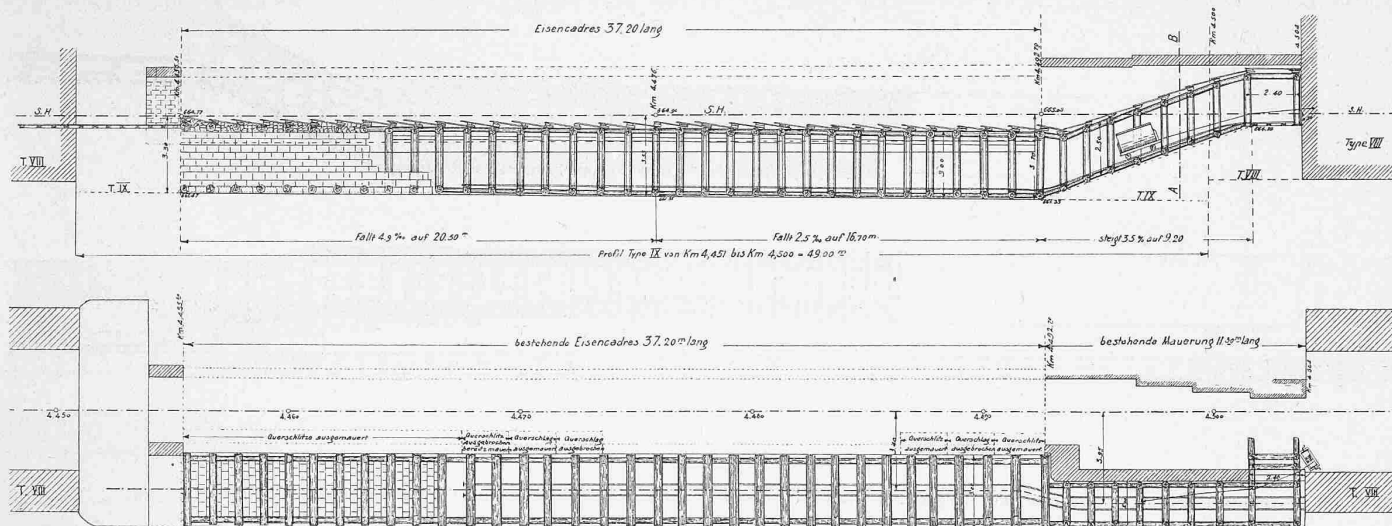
und 5. Grundriss und Längsschnitt des Unterstollens rechts (östlich). — Masstab 1 : 300.
